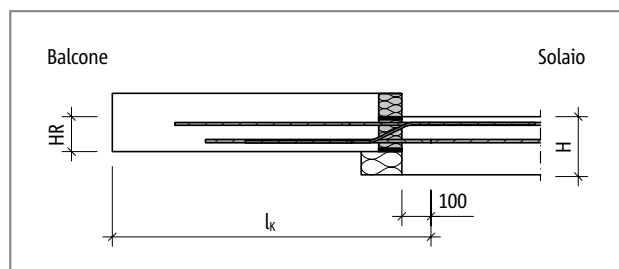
Schöck Isokorb® T tipo KL-OD: schema statico
